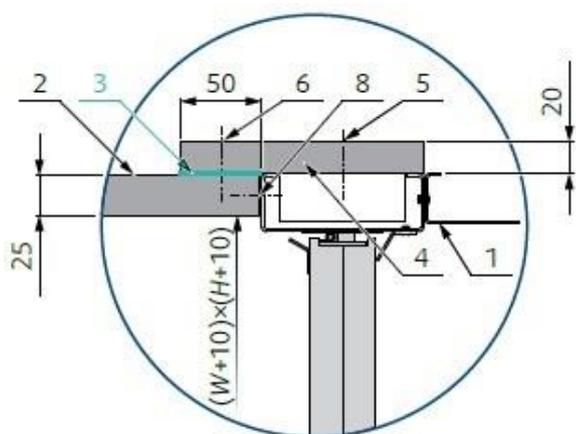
Sezione trasversale del collegamento con lastra della condotta di spessore 25 mm
